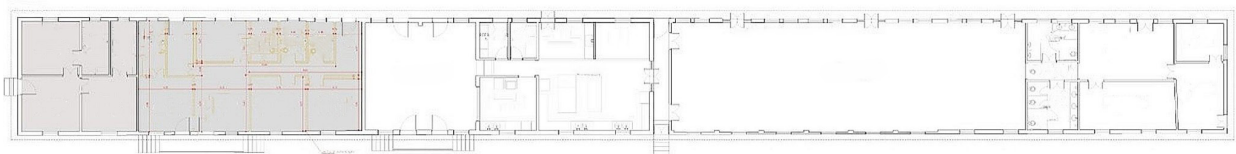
Planta arquitetônica da antiga senzala com destaque da área escavada. Acervo Scientia, 2025.
